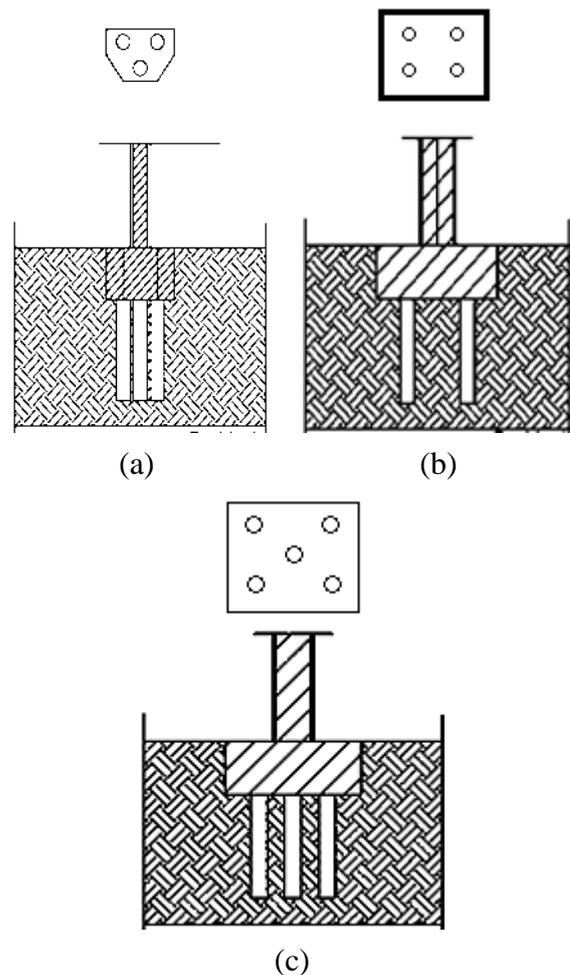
Lapisan Tanah dan Kedalaman Tiang Fondasi
